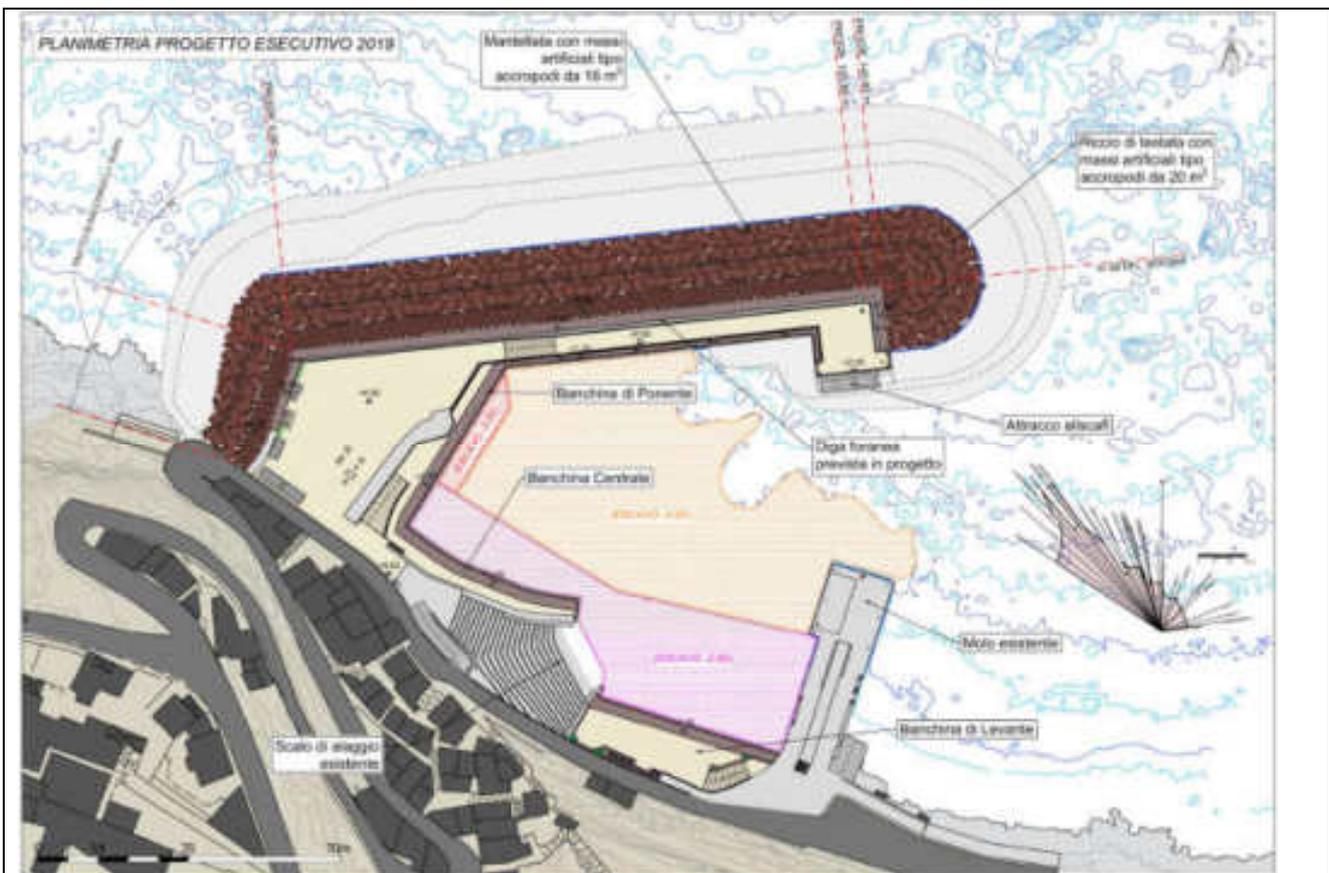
Planimetria progetto esecutivo in corso di realizzazione
